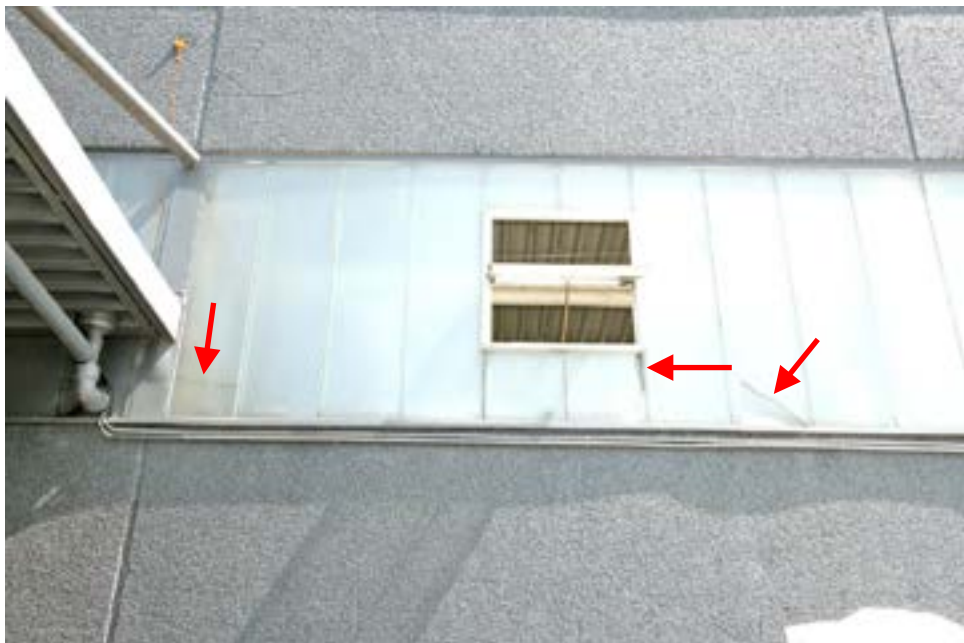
Schadhafte Glasscheiben im Lichtband an der Nordwestseite von Halle 1 (1. Bauabschnitt)
